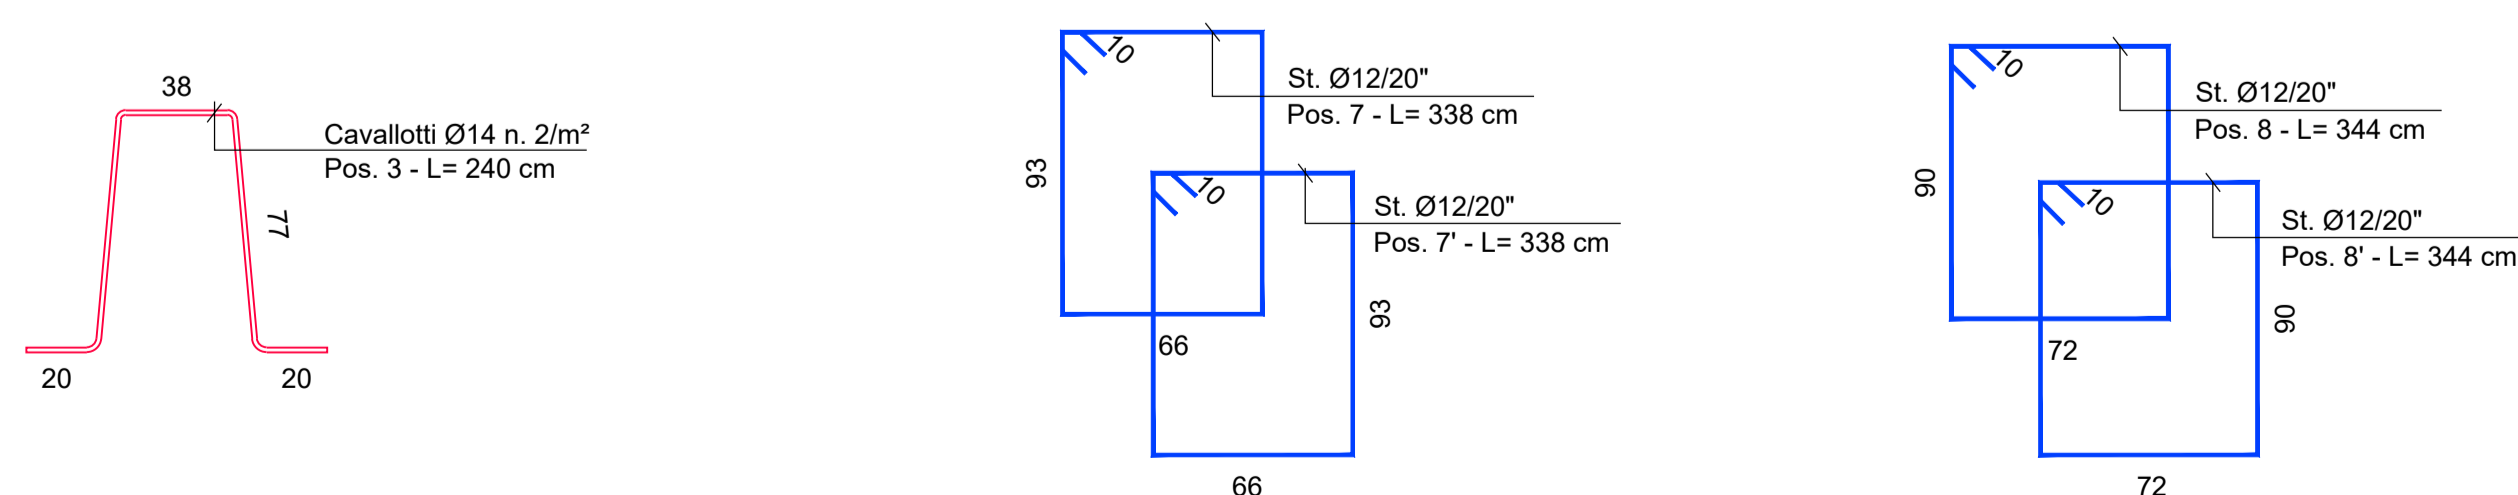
PLATEA IN C.A. STRALCIO PIANTA ARMATURA
